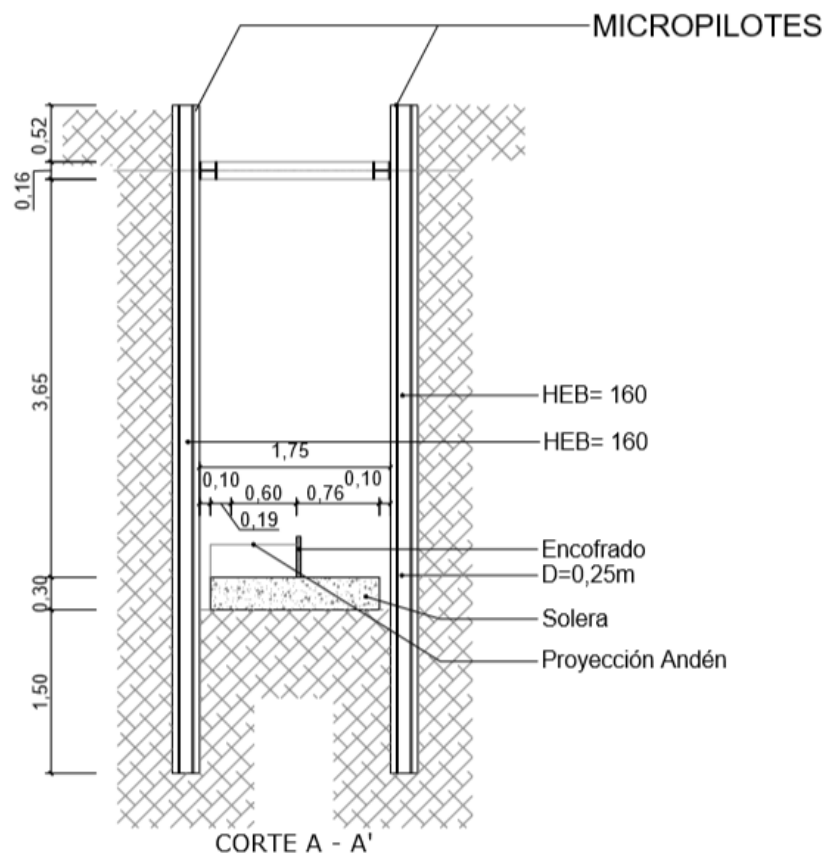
D5-Detalle hormigonado andén en sección de tramo 1-2-3
